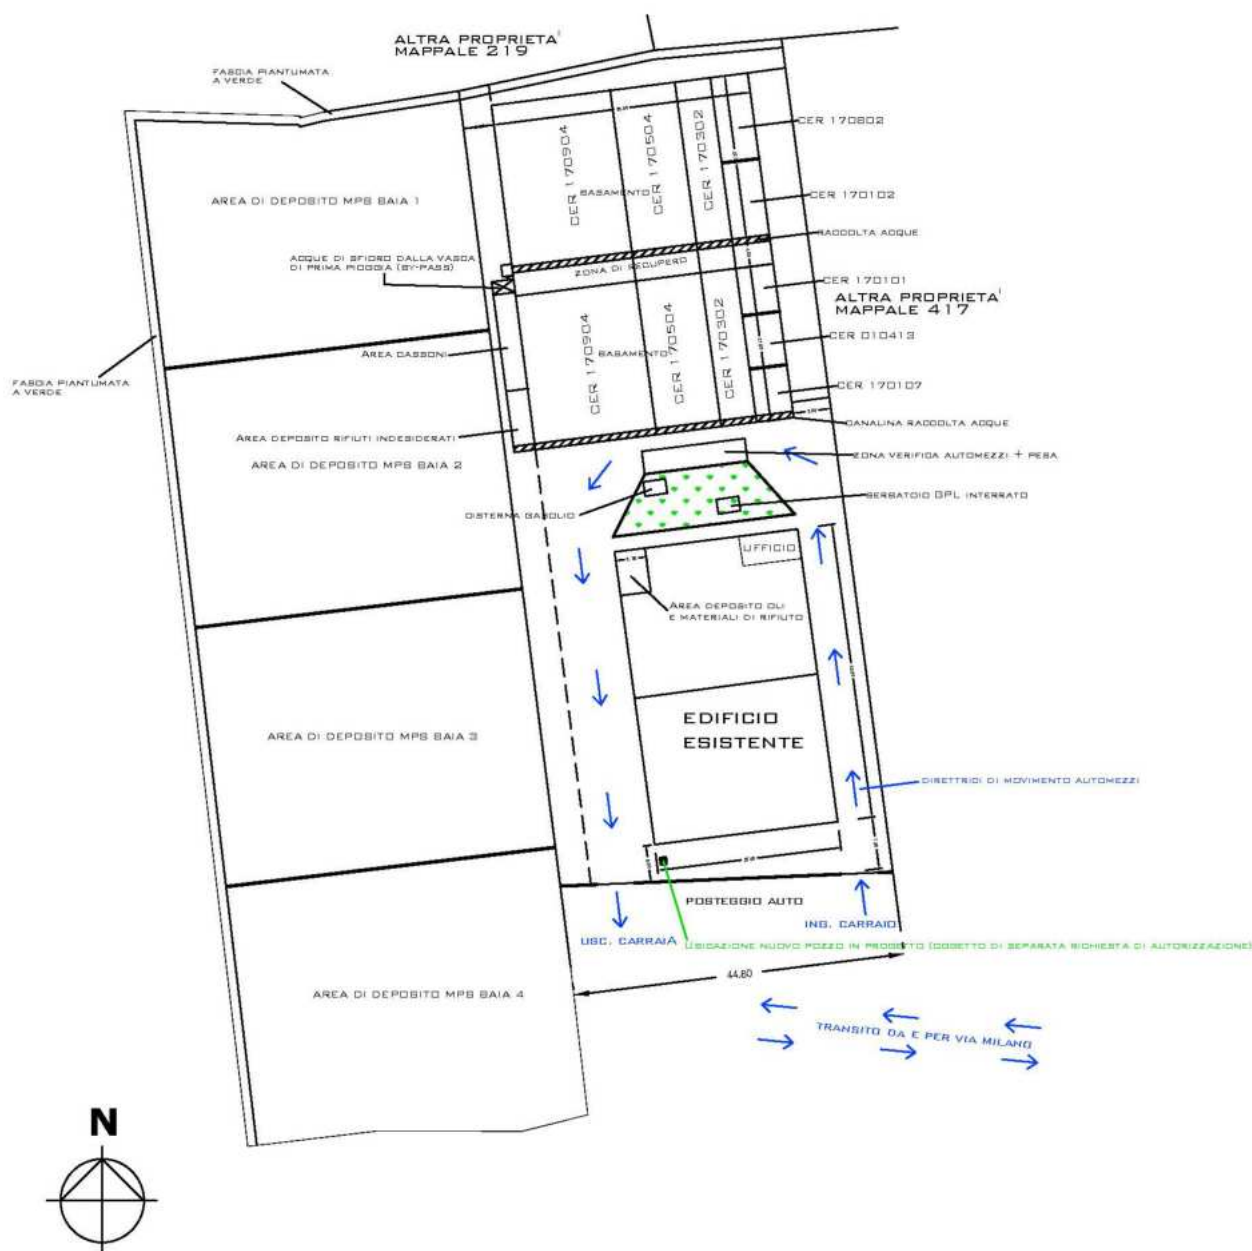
Planimetria del sito in trattazione (planimetria generale Art. 208)
